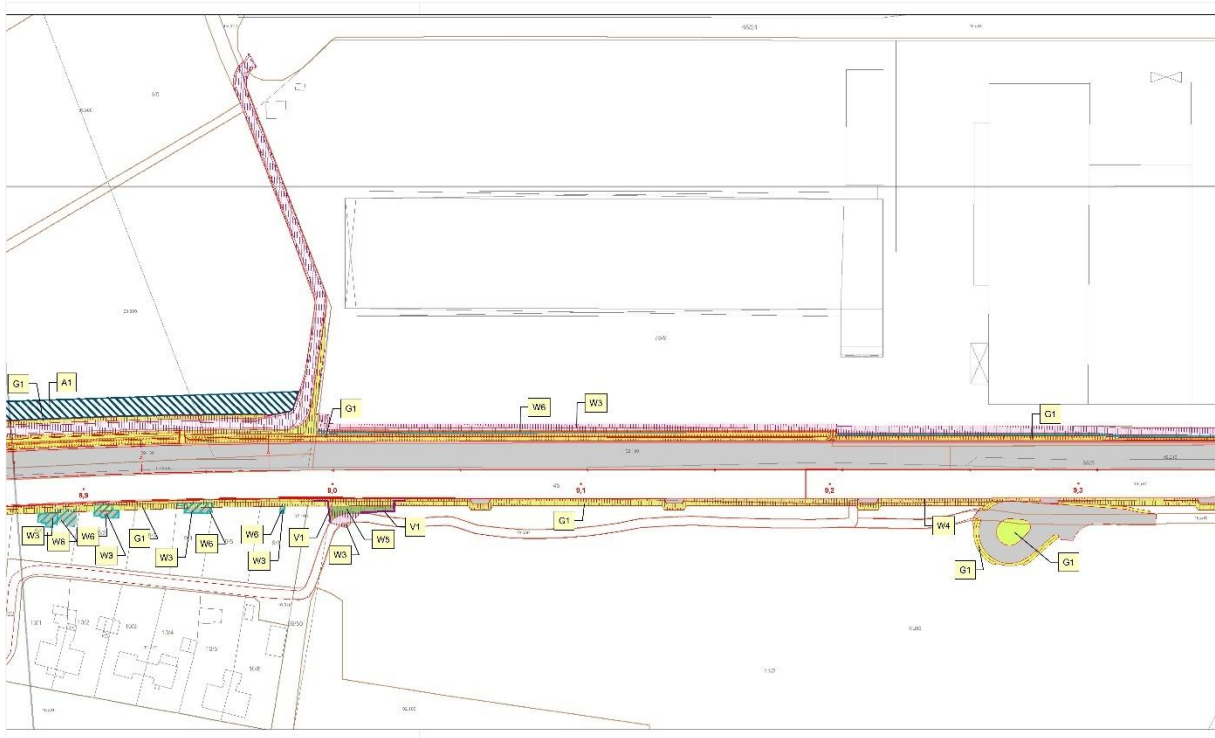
Ausschnitt aus dem Maßnahmenlageplan Planfeststellung – S-Bahn Rhein-Main, Nordmainische S-Bahn.
